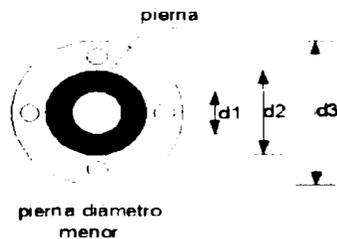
Diagrama de conexión Pierna-Pierna
